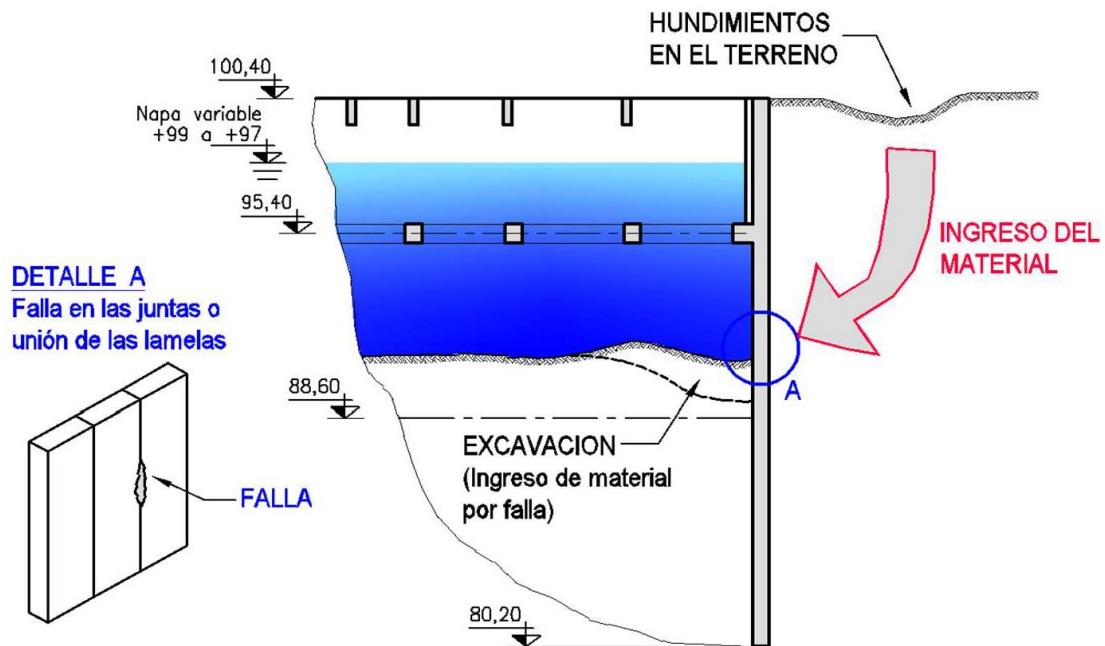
Falla de juntas de pantalla de hormigón armado
